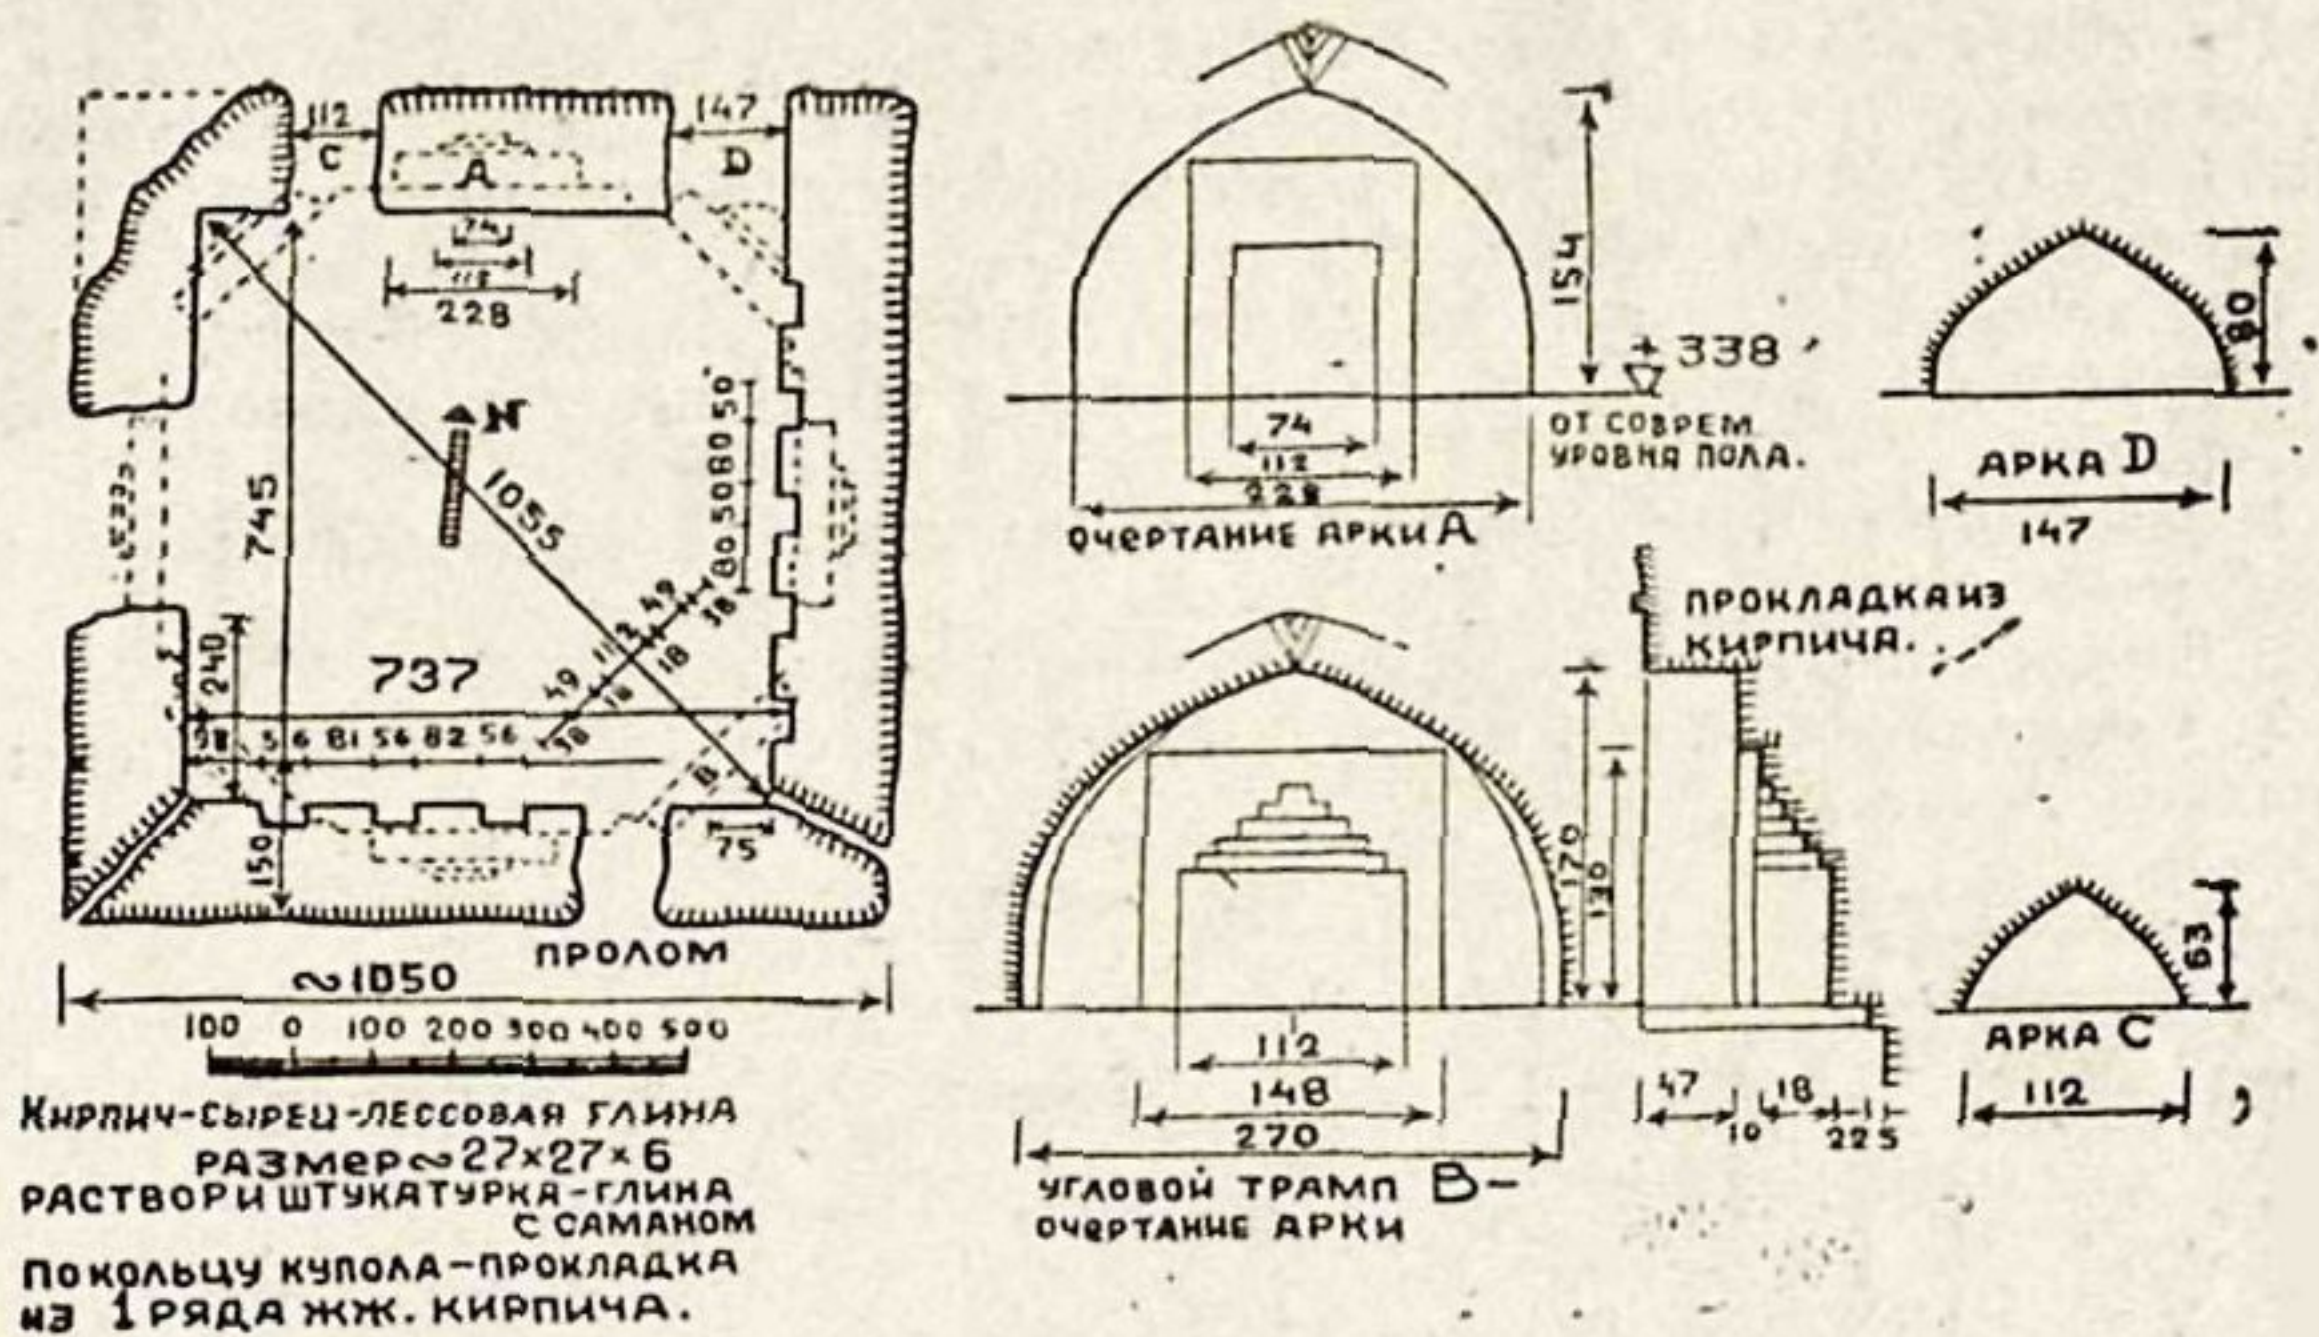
План сырцового здания № 10 и обмеры деталей.
